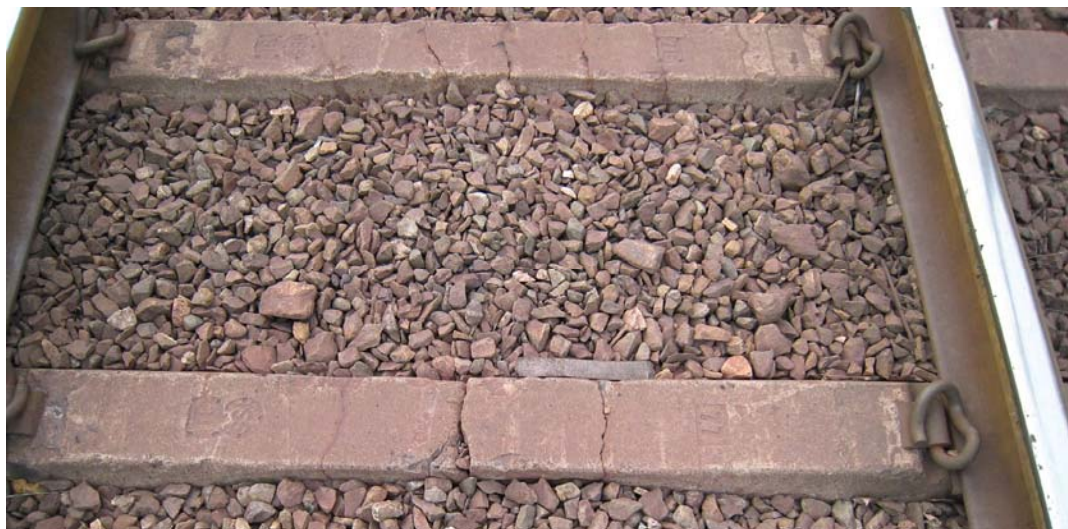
Risse in den Einblock-Betonschwellen
